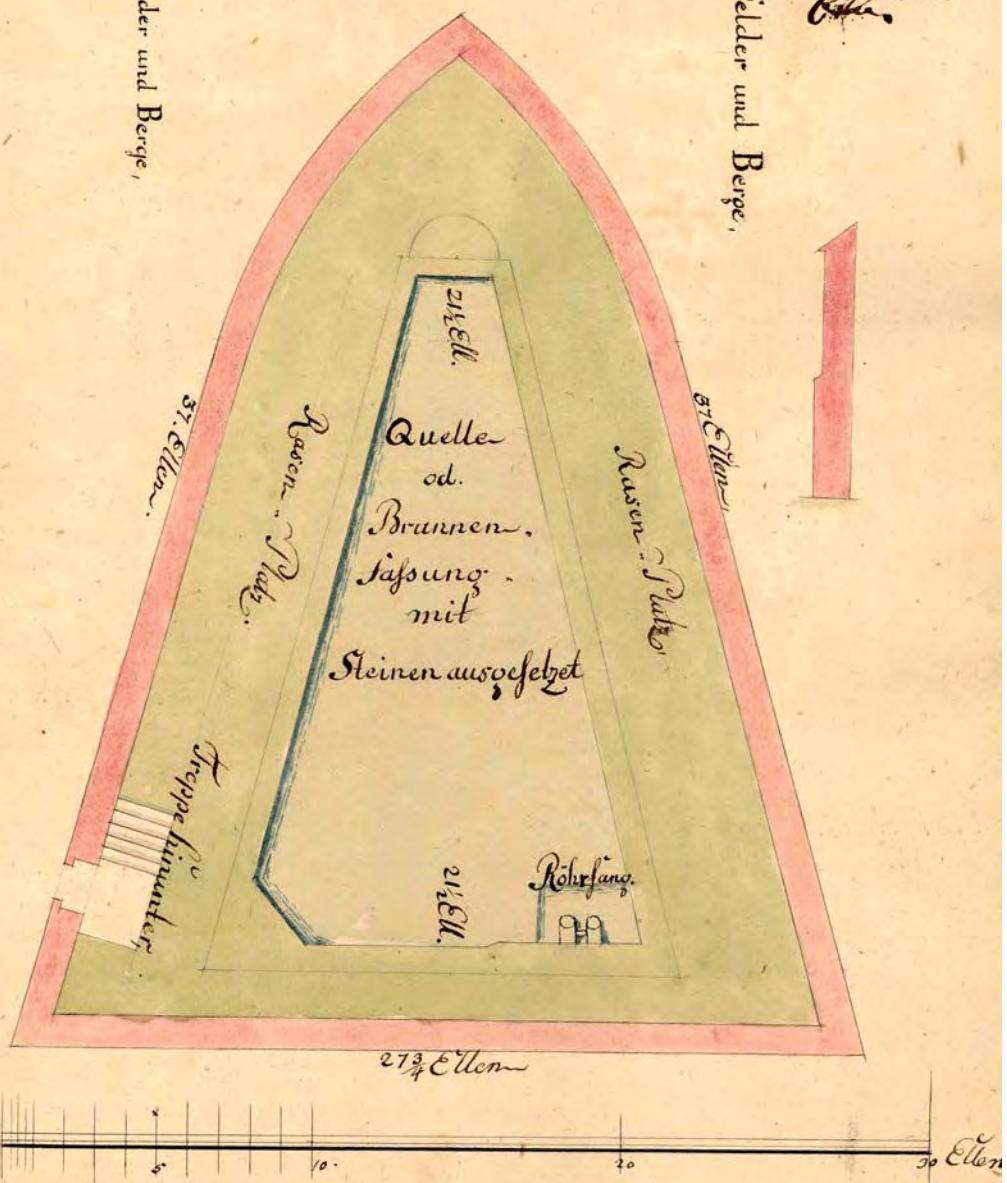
Grundriss des Heiligen Borns 1732
